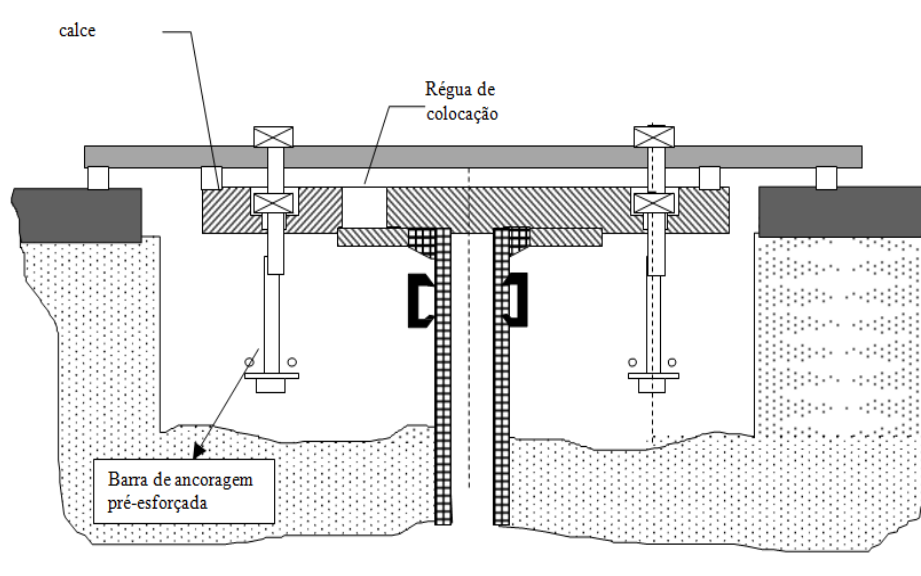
Pormenor das ancoragens previamente à betonagem
